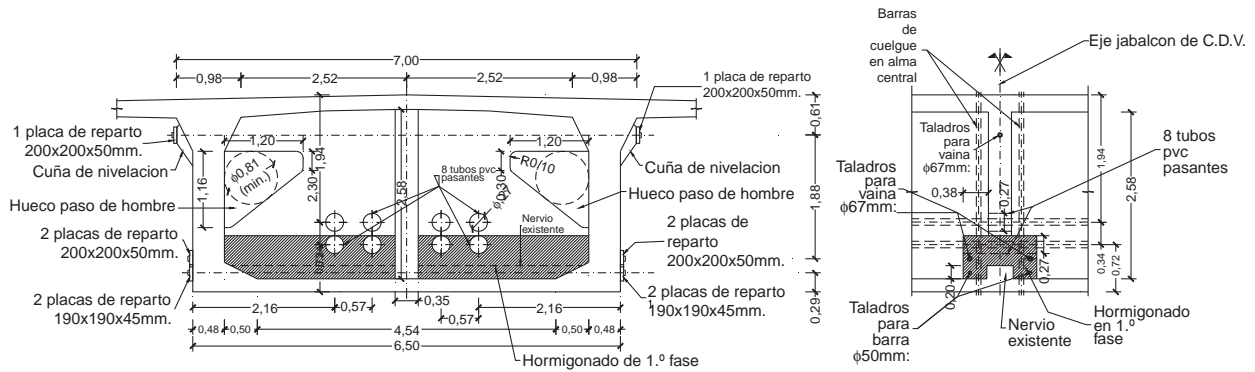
Alzado y sección transversal de los rigidizadores transversales de centros de vano (no se representa el cajón metálico).
